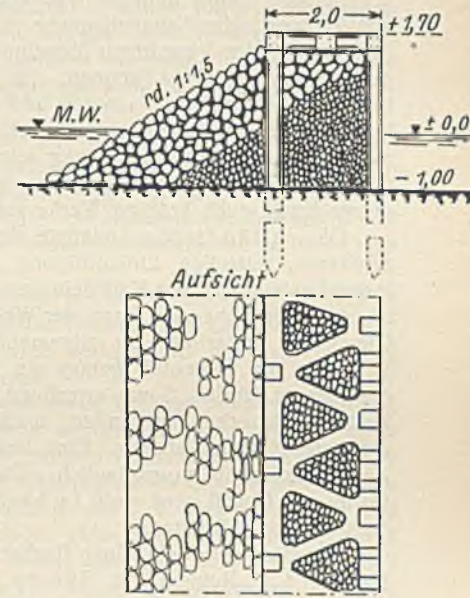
Querwerk aus Eisenbeton bei Marina di Pisa (Arnomündung).
